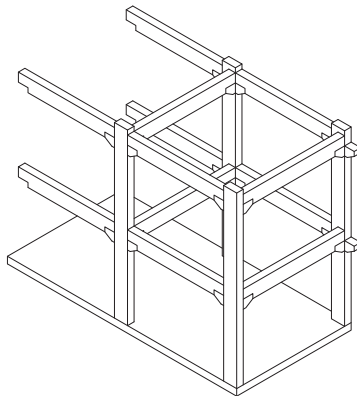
Axonometría constructiva sistema viga-pilar de hormigón prefabricado.
